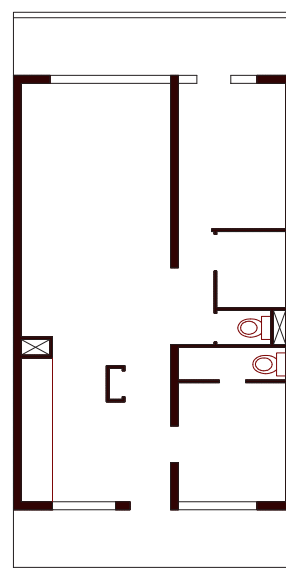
Planta tipo A- DeFlat Kleiburg - NL Architects
